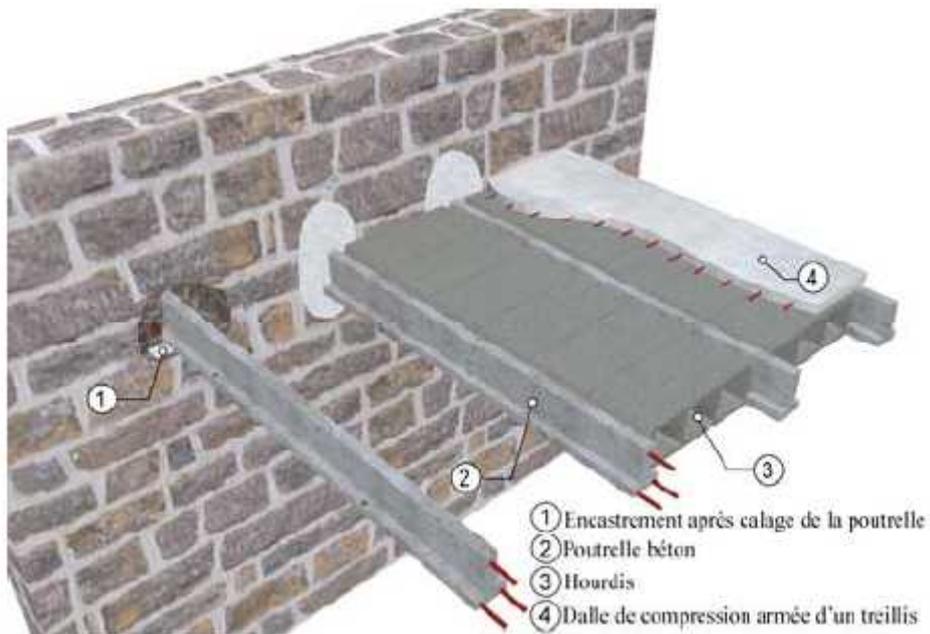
Plancher à poutrelle en béton armée encastree dans le mur.
